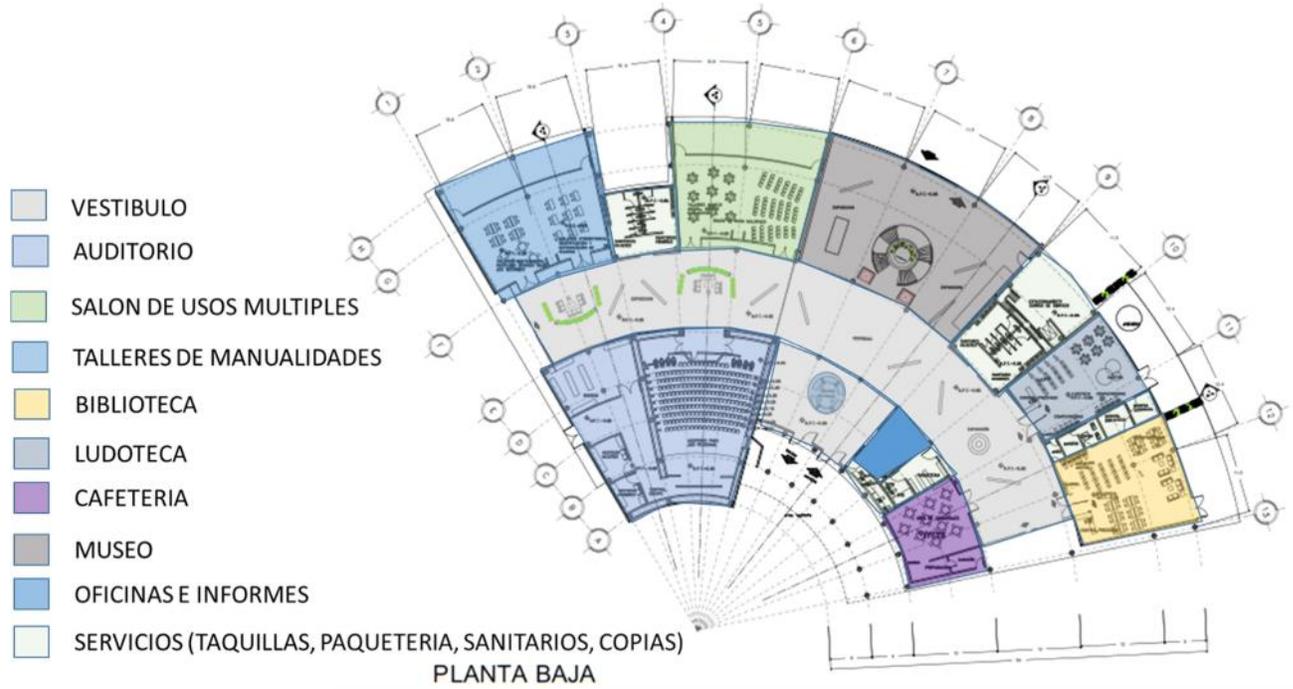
Zonificación planta baja. Fuente: el autor
